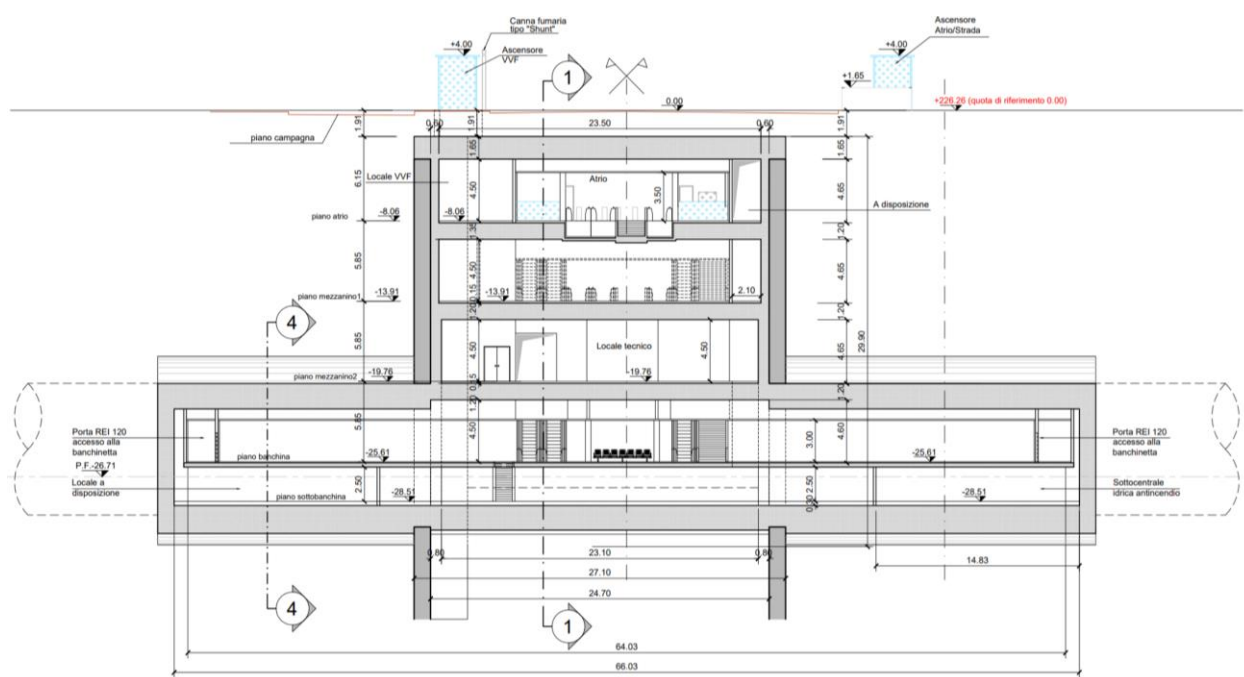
Sezione longitudinale della stazione tipologica con galleria di banchina
